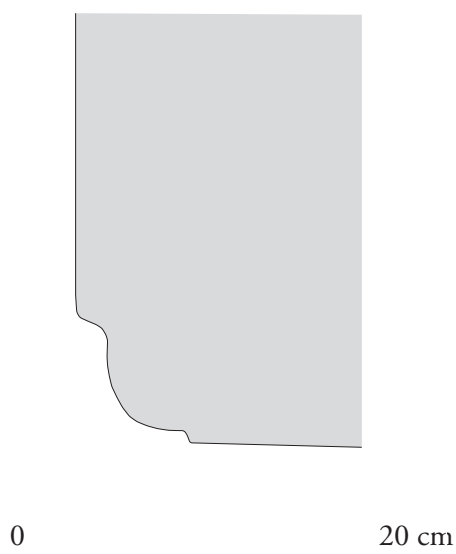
Coupe de la base en sifflet d'une croisée (DAO Cédric Moulis).
